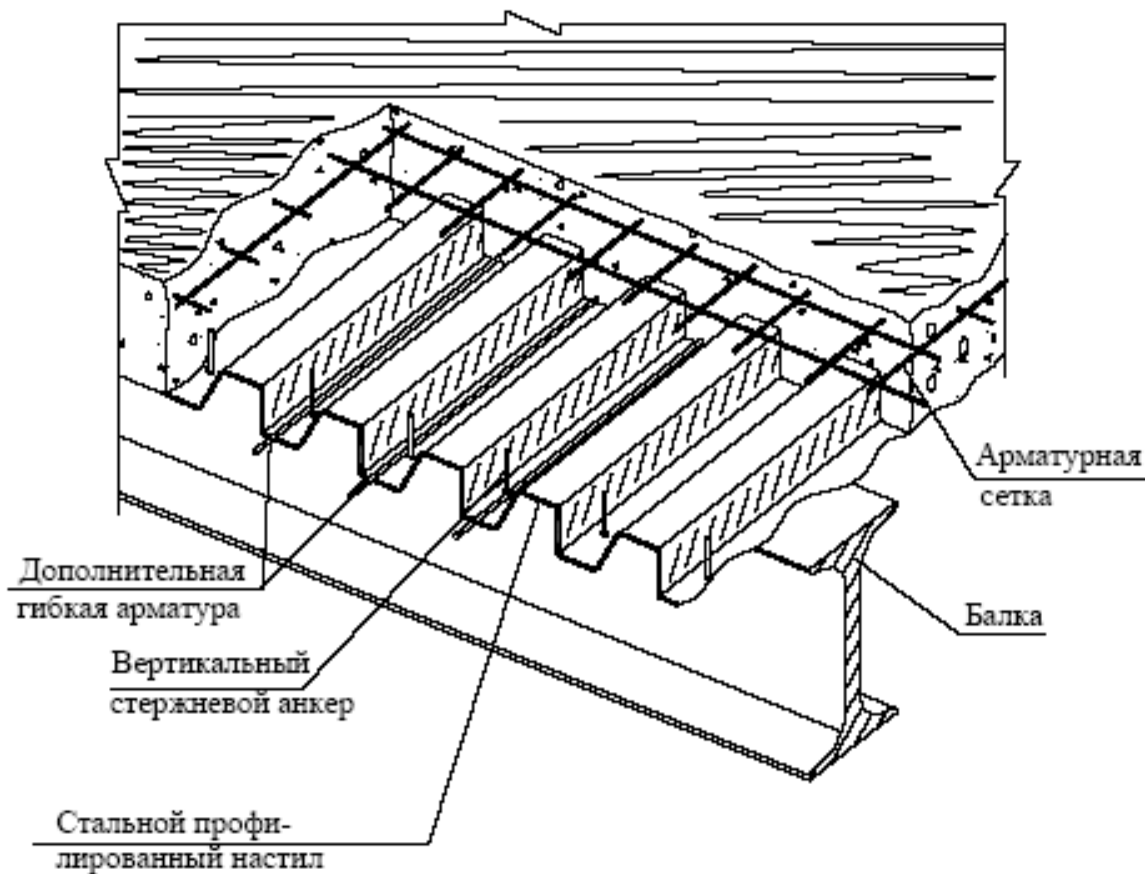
Конструкция монолитного перекрытия с применением стального профилированного настила Н80А-674-1,0 в качестве несъемной опалубки и внешней арматуры
